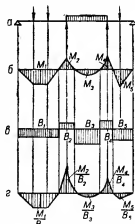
Схема нагрузок и эпюры моментов, жесткостей и кривизны в железобетонном элементе: а — схема нагрузок; б — эпюра моментов от нормативной нагрузки; в — эпюра расчетных жесткостей на различных участках элемента; г — расчетная эпюра кривизн.
